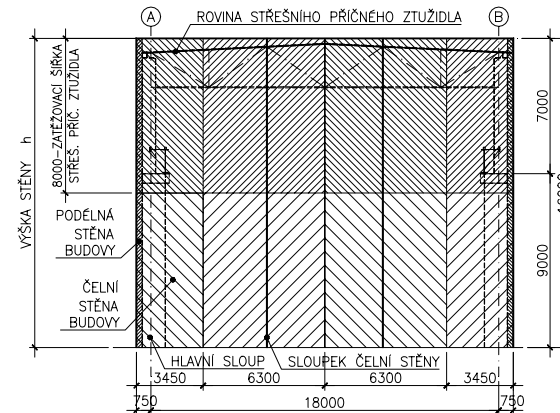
Půdorys umístění příčných střešních ztužidel
